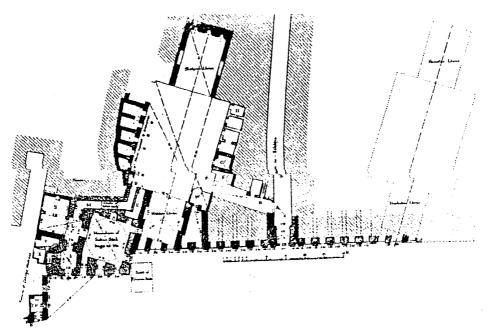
مسقط أفقي لجامع داود باشا بالقاهرة .
